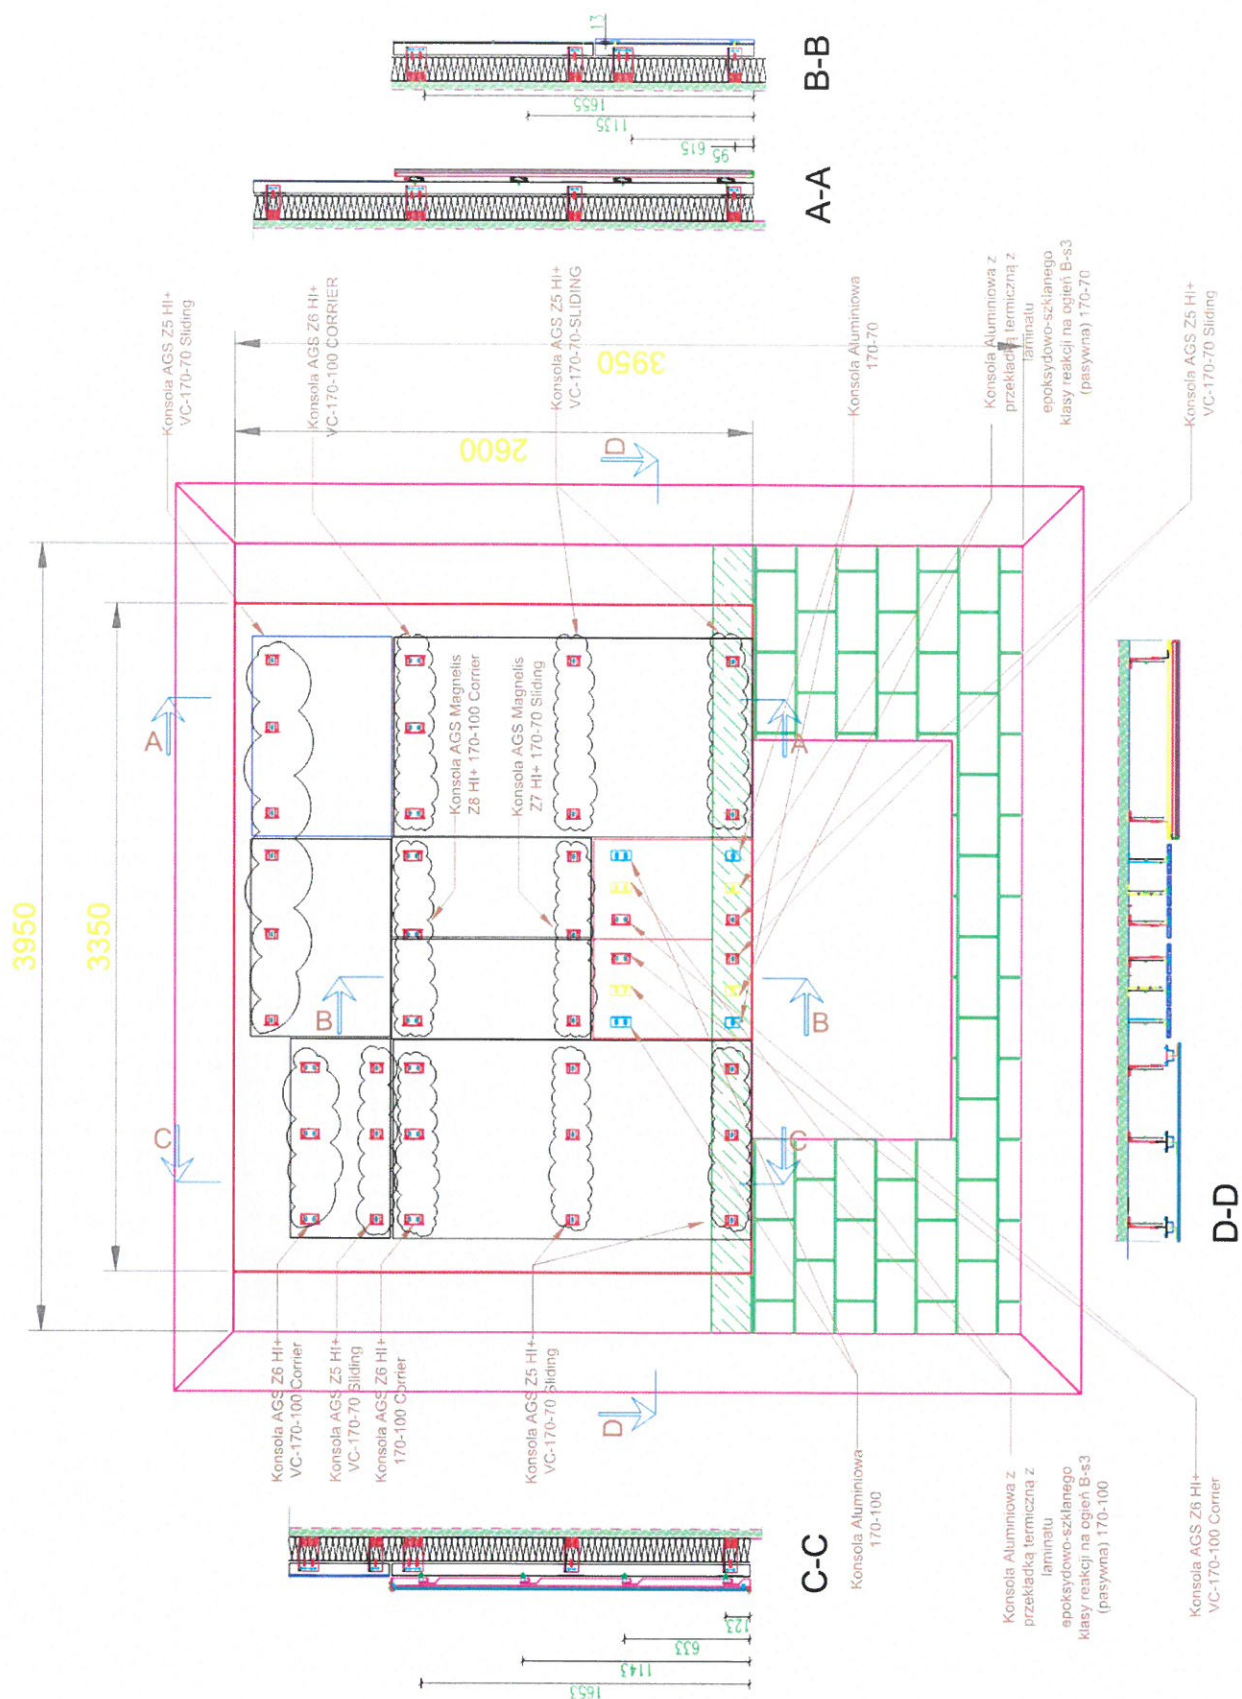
Widok i przekroje badanego elementu – opis okładzin.
